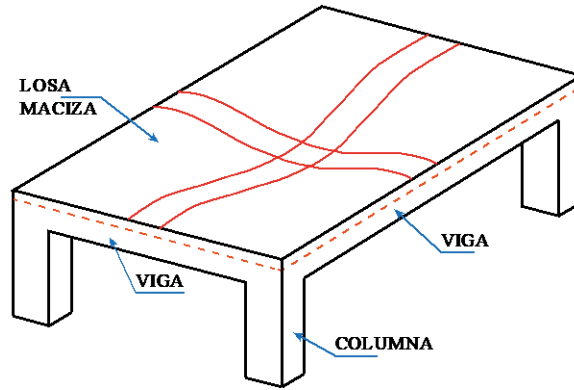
Esquema de losa en dos direcciones sobre bordes viga.
